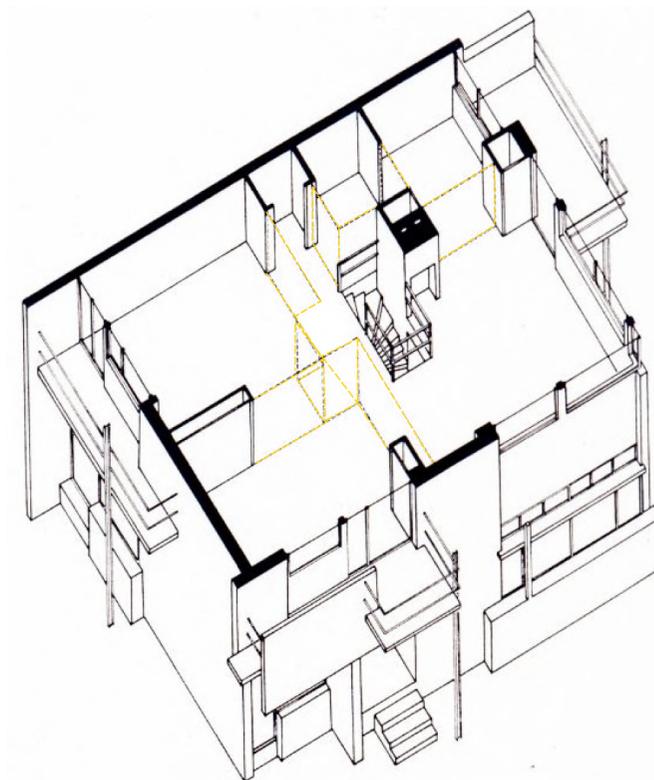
17: Axonometría de casa Schröder (proyección de vivienda del futuro).
